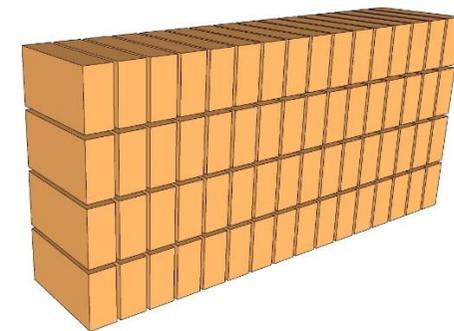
Aparejo tipo sardinel, Fuente: elaboración propia
